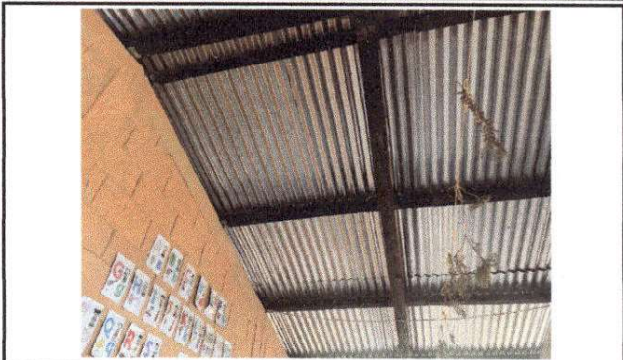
Se requiere remozamiento de estructura portante de cubierta de lámina.
